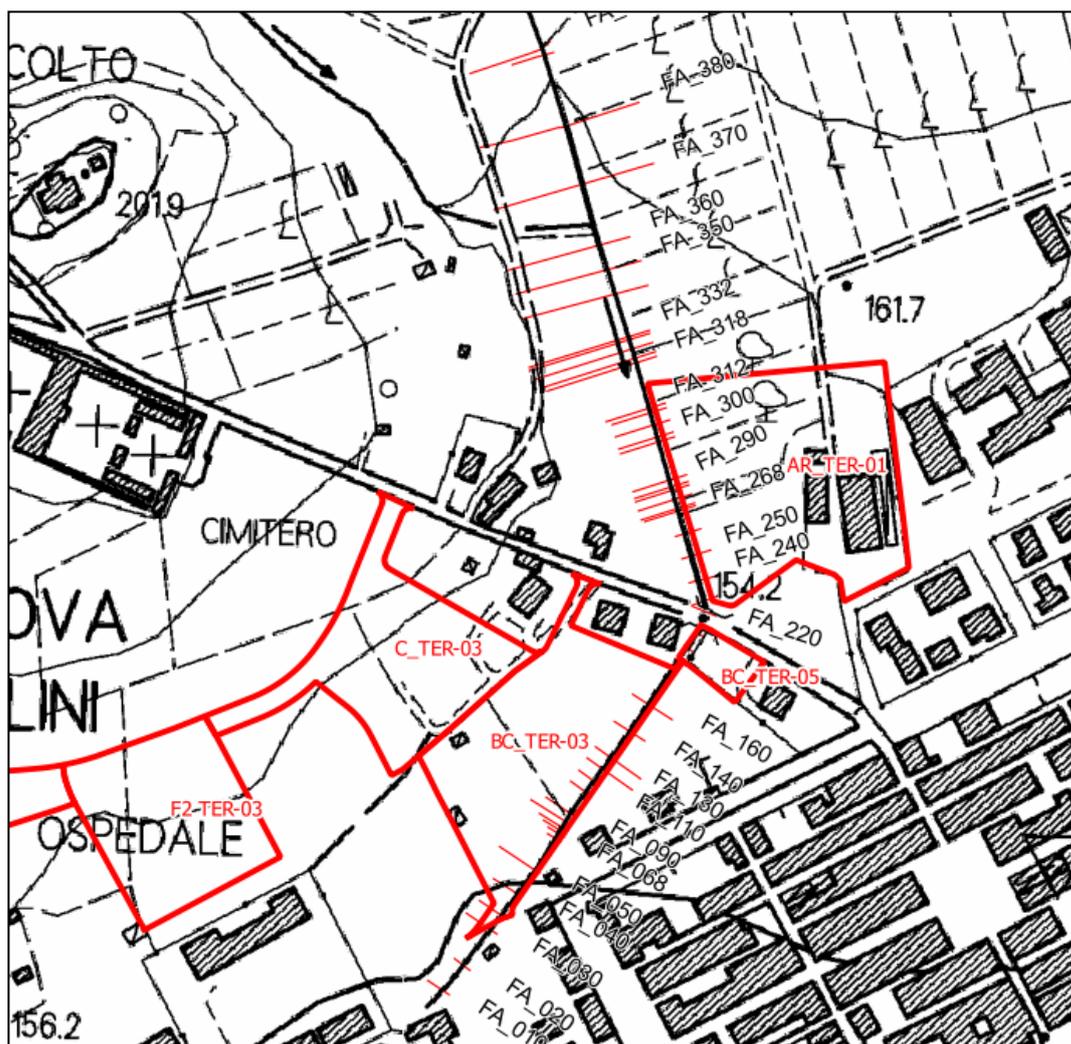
Fosso Fratta - planimetria sezioni trasversali.
